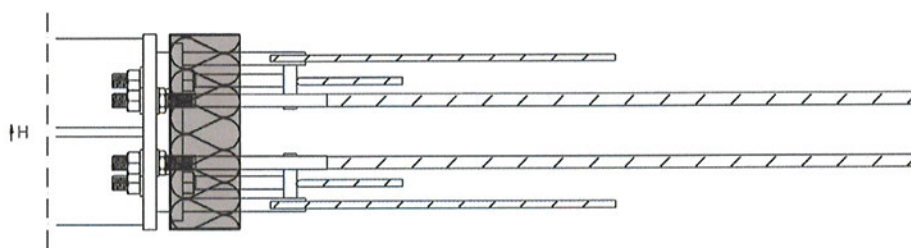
Grundriss Isopro Typ SBM14 Q8 und SBM14 Q10
